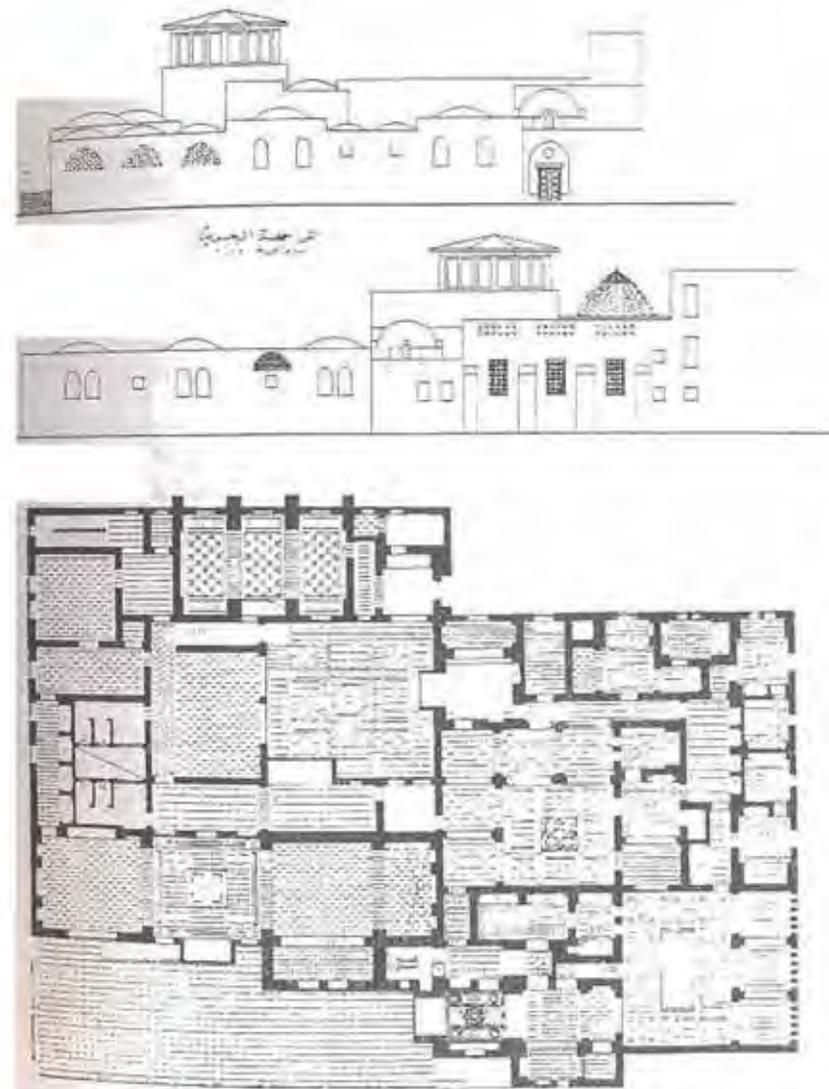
Grundriß und Fassaden des Palastes in Kuwait
